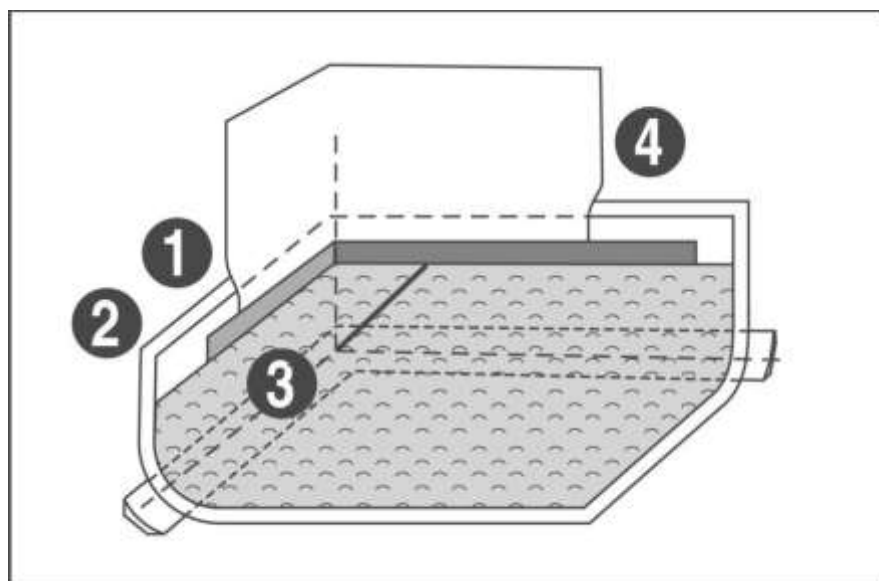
Pavimento de resina na vertical: vedação direta
